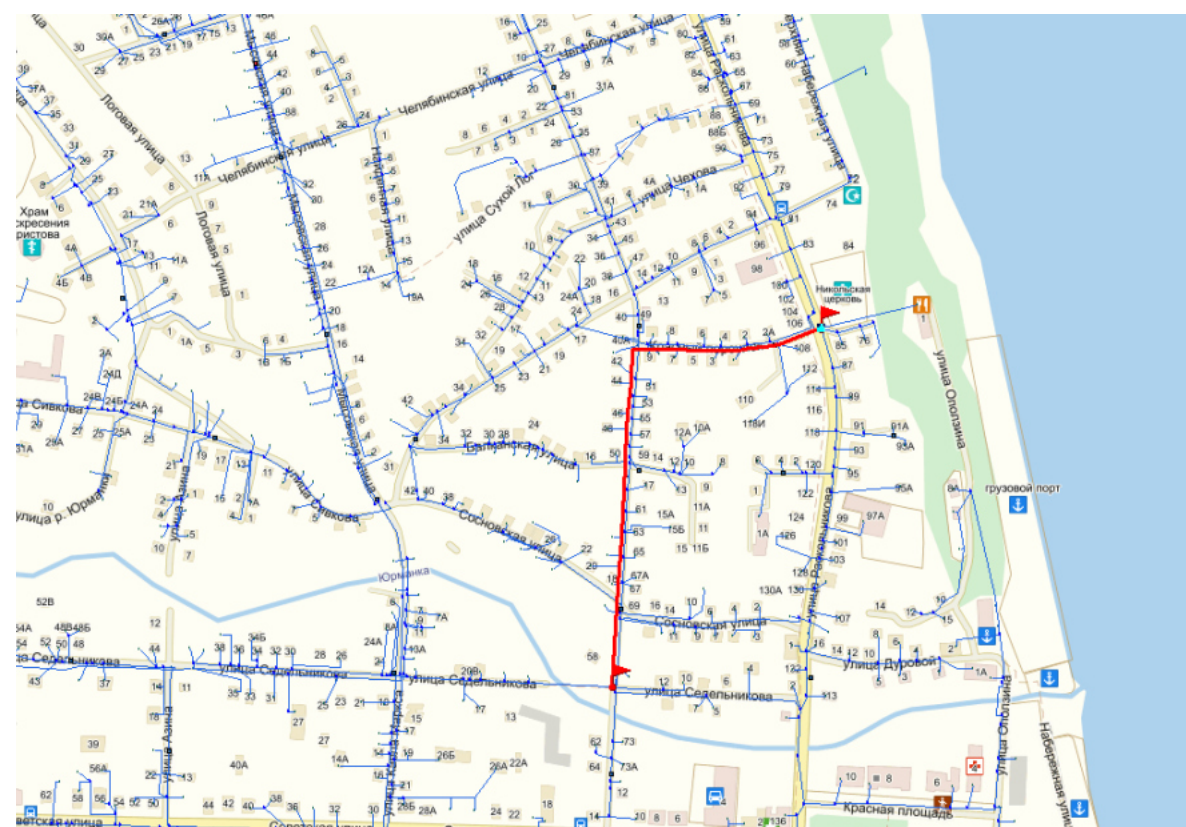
Участок водопроводной сети от ВК-5-2-65-1 до Узел-5-2-80
